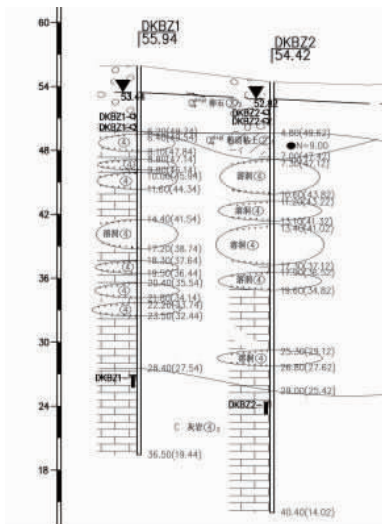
Q0-13# 与 Q0-16# 桩地质纵断面图
